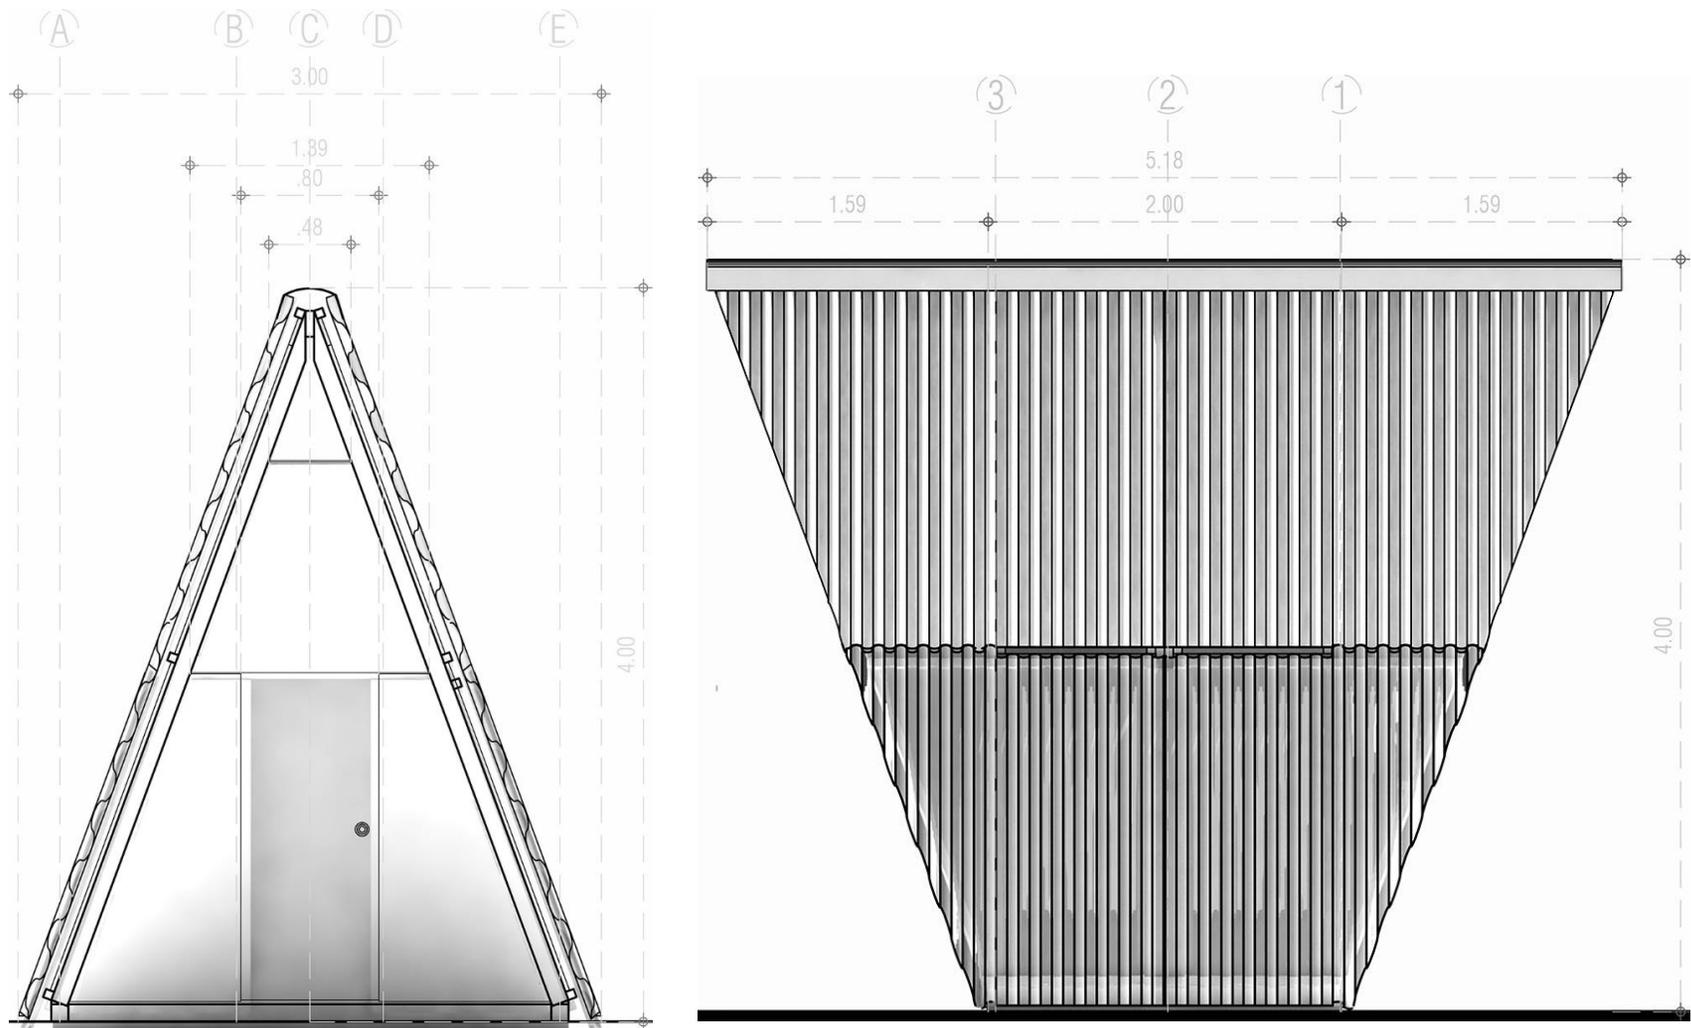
Elevación Frontal y Lateral Casa Techo armada
